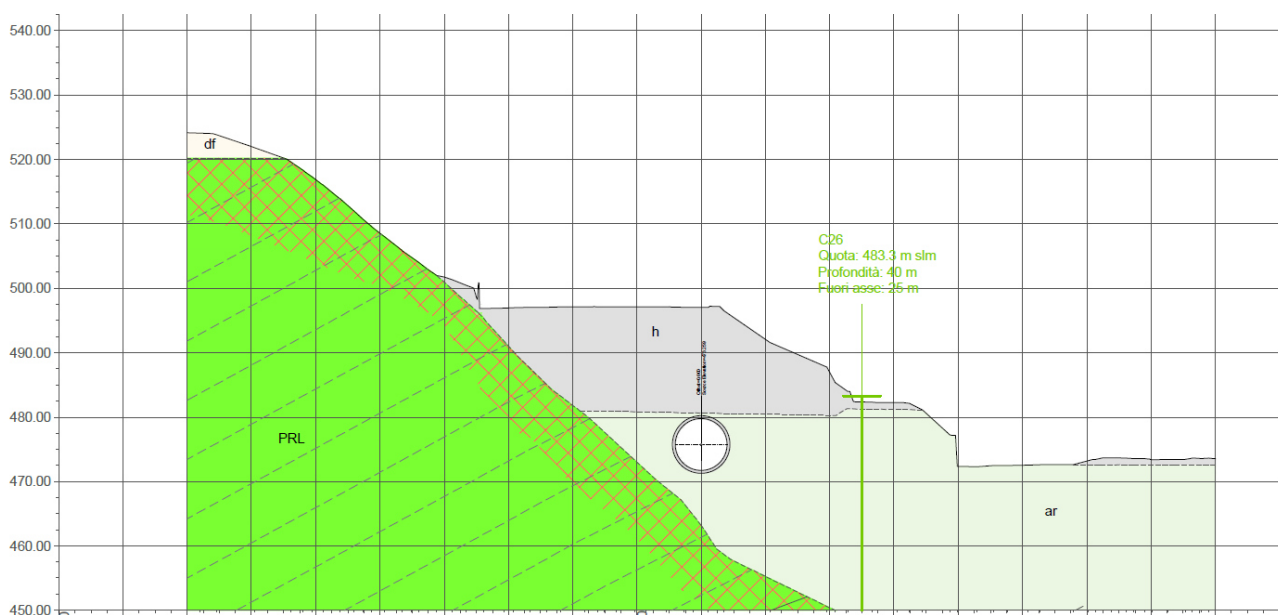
Stralcio del planoprofilo di dettaglio dell'imbocco binario dispari con la sezione trasversale all'altezza delle pk 3+163 attraverso il rilevato dell'autostrada A22- elaborato IBOU1BEZZL7GE0001006B.
